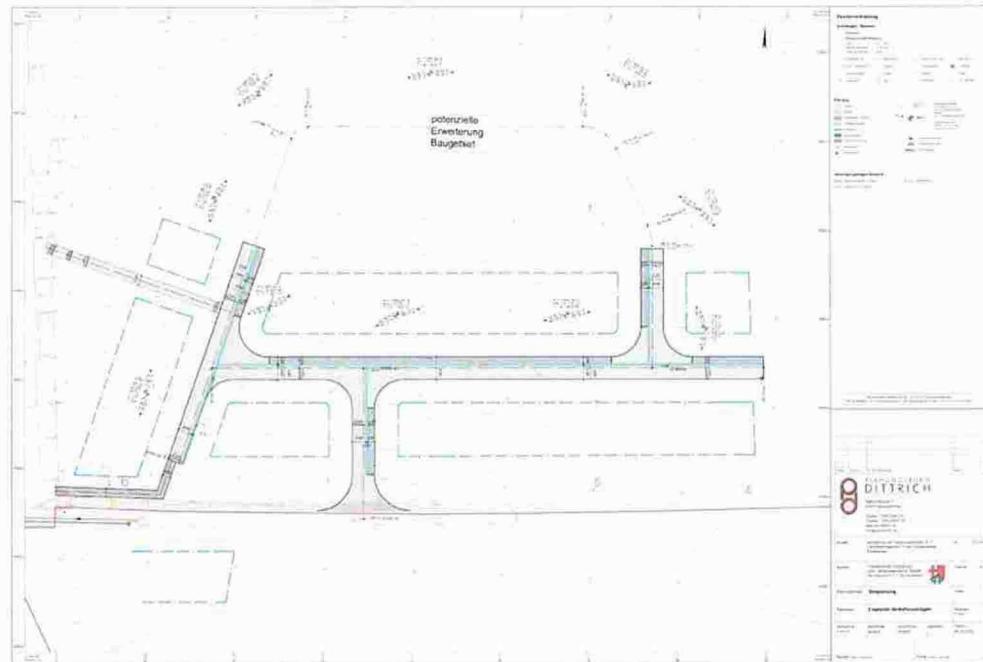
Lageplan aus der Fachplanung zur Verkehrseröffnung vom 06.02.2023
